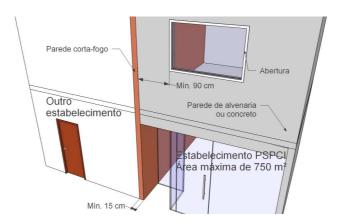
B – Recuo de 90 centímetros, afastamento de 1 metro entre aberturas e emprego de vidro de segurança com exigência de área livre de materiais – Detalhe segundo pavimento
